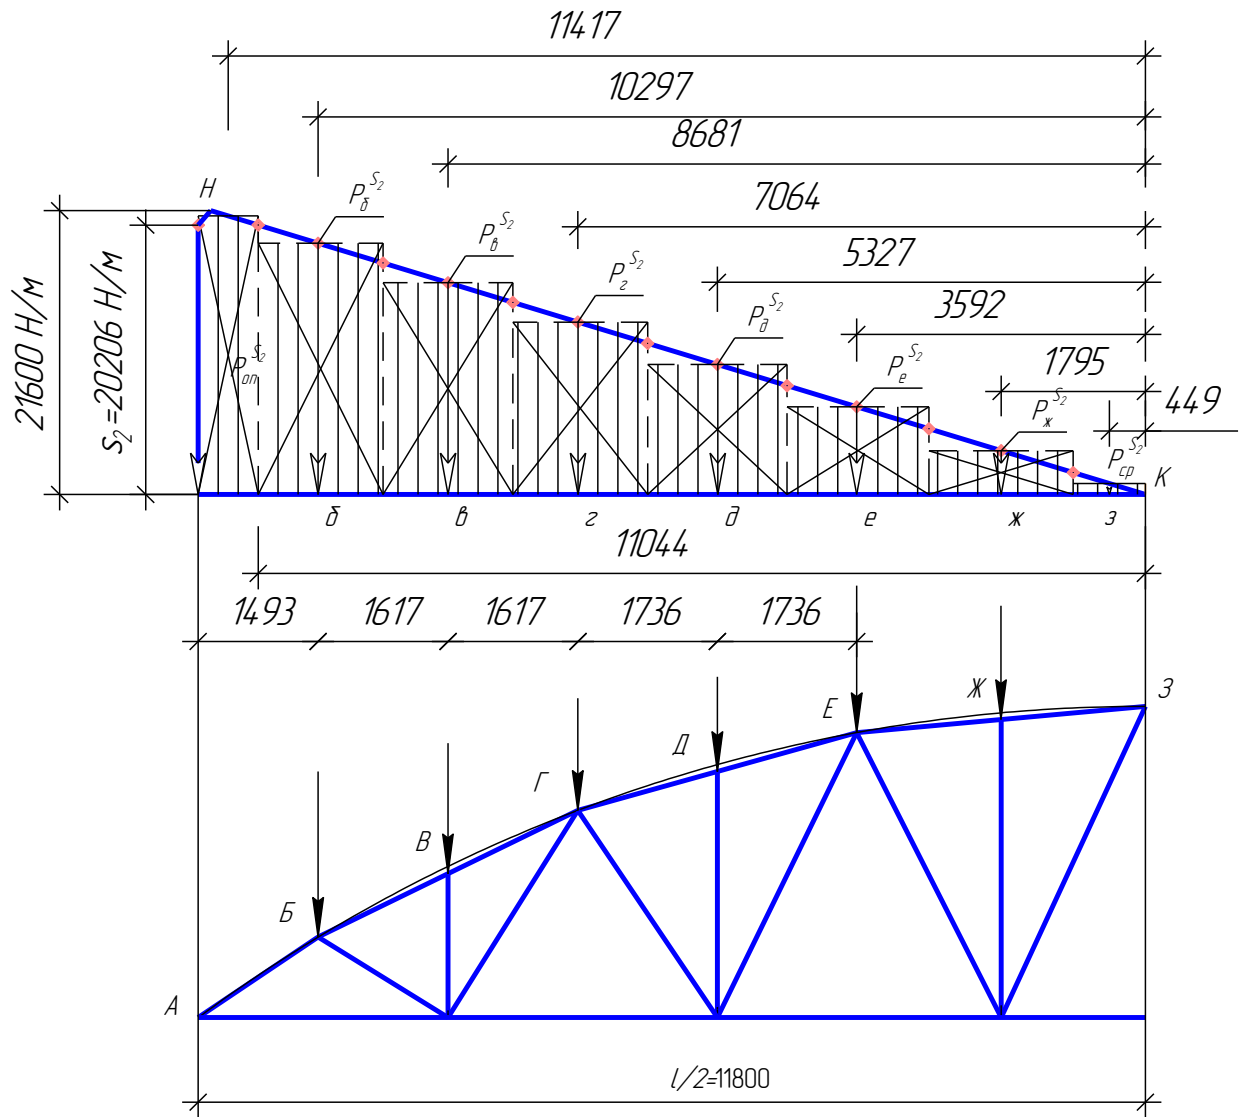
Схема определения узловых нагрузок от снега распределенного по треугольной эшпоре
